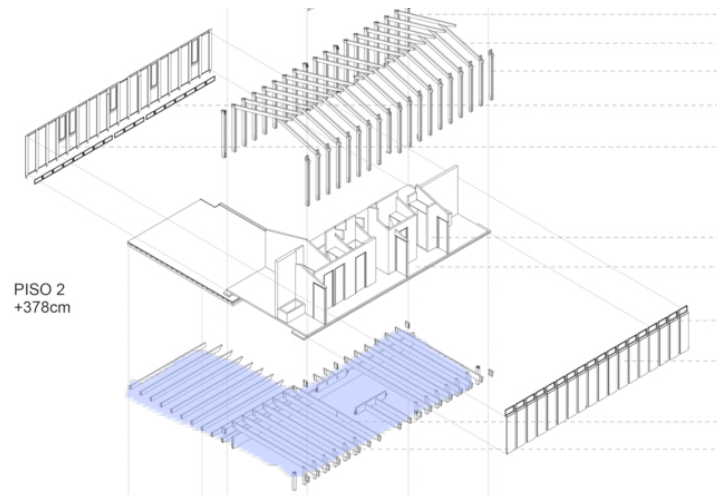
Planta arquitectónica del conjunto Alcántara. Análisis propio
